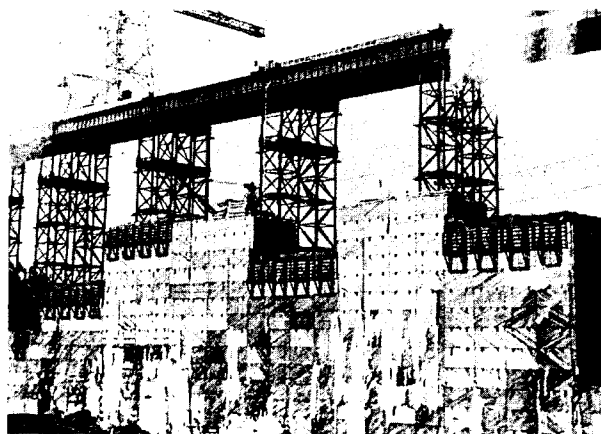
Укладка бетона в консольной опалубке со съемной палубой зимой на Усть-Илимской ГЭС
